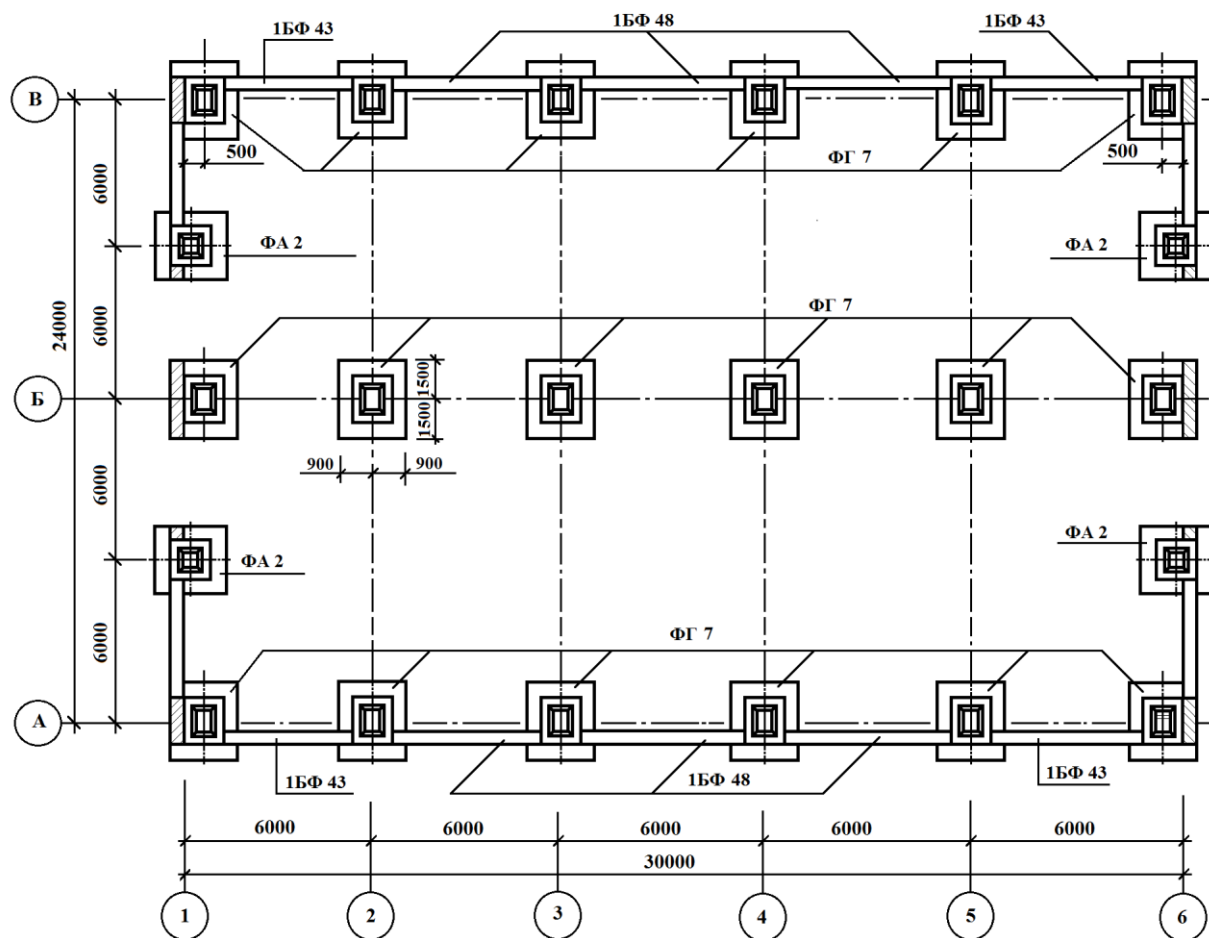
Маркировка фундаментов, фундаментных балок и простановка размеров
